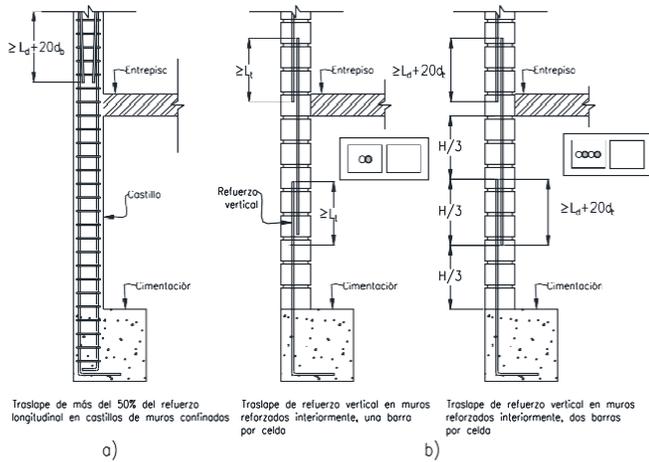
Longitudes de traslape de barras, a) en castillos de muros confinados y b) en muros reforzados interiormente
